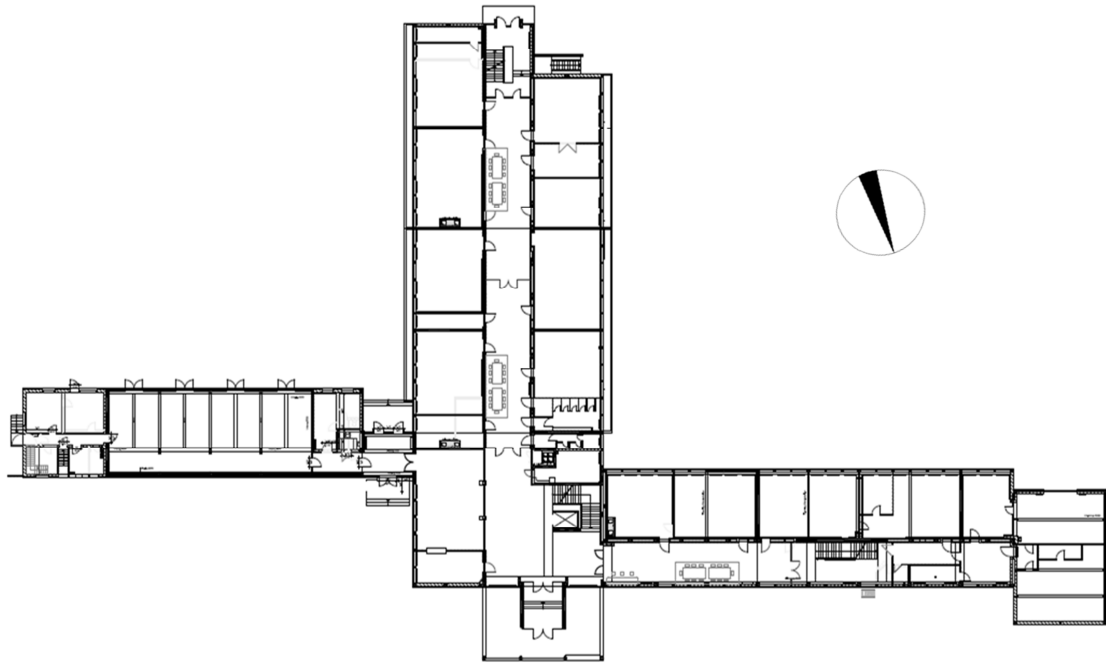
Grundriss EG Berufsbildende Schule Metall- und Elektrotechnik, Hannover
